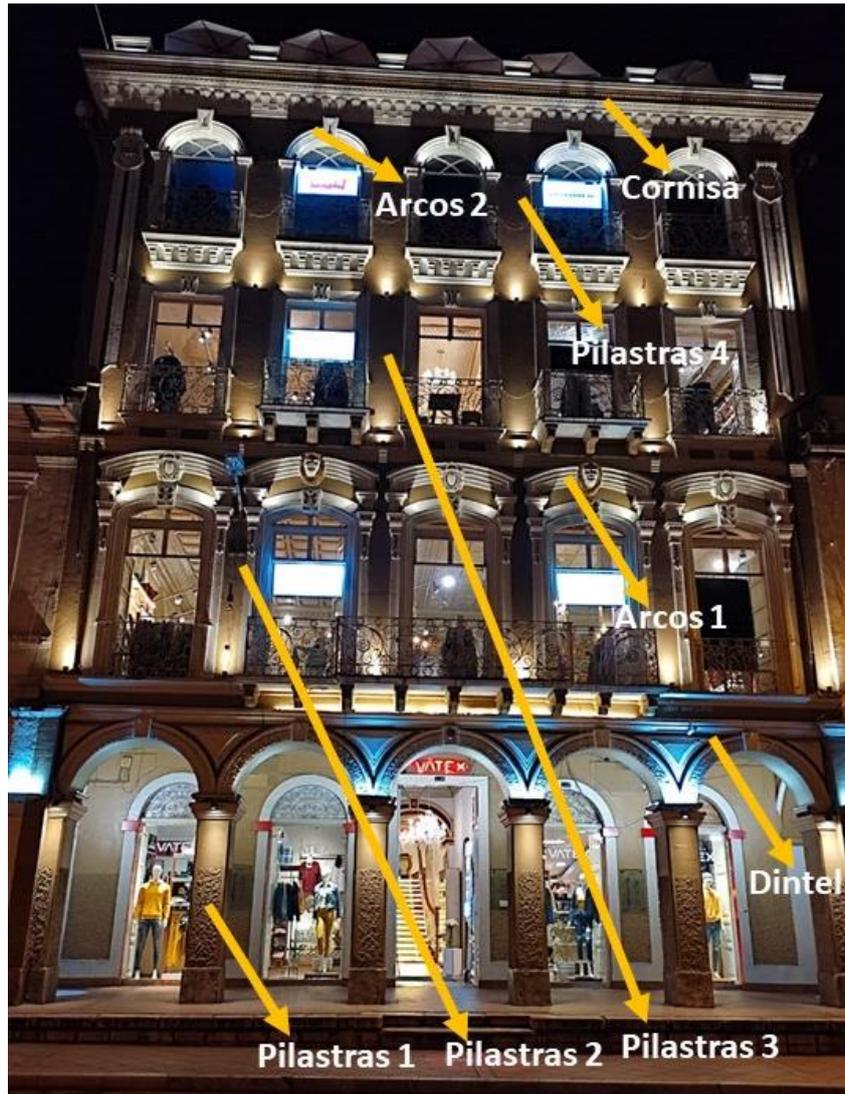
Secciones de la fachada frontal edificio de Vatex (familia Calero). [Autores]
